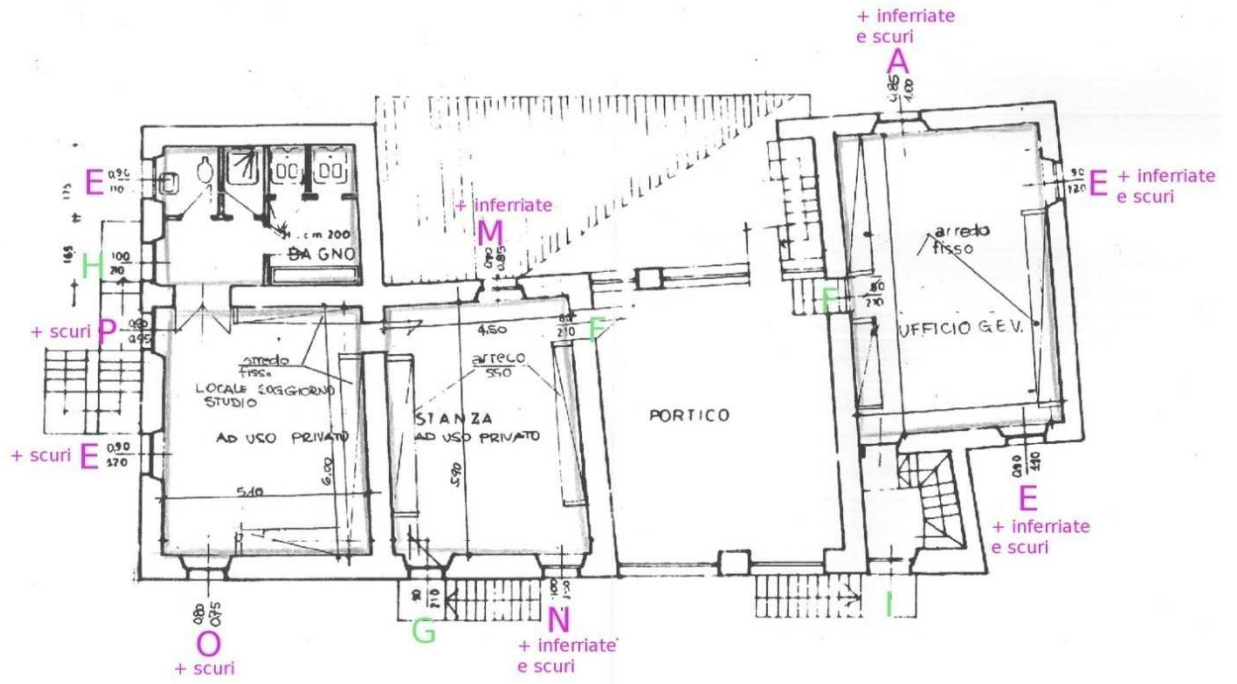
planimetria del primo piano di Ca' Soldato
